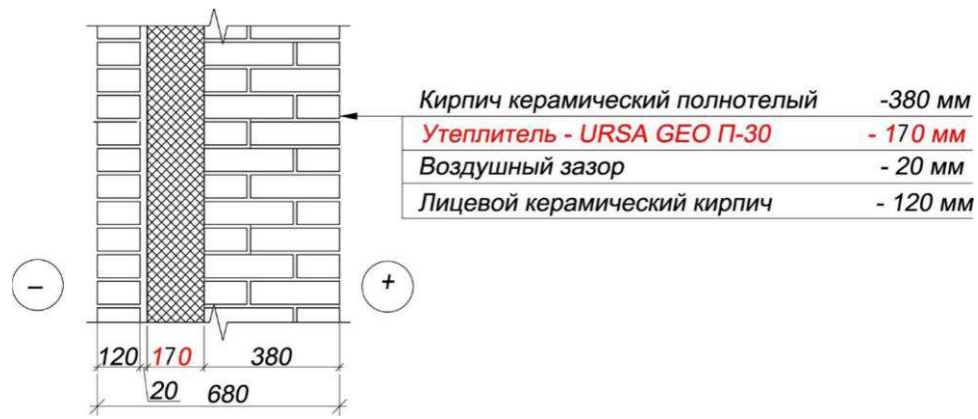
Расчетная схема наружной стены с несущим слоем из кирпичной кладки толщиной 380 мм
